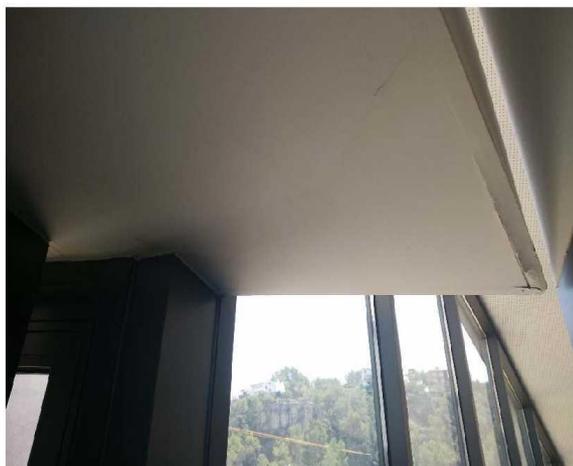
Probablemente haya fallado el sumidero de cubierta que se encuentra justo en la vertical de este punto.
